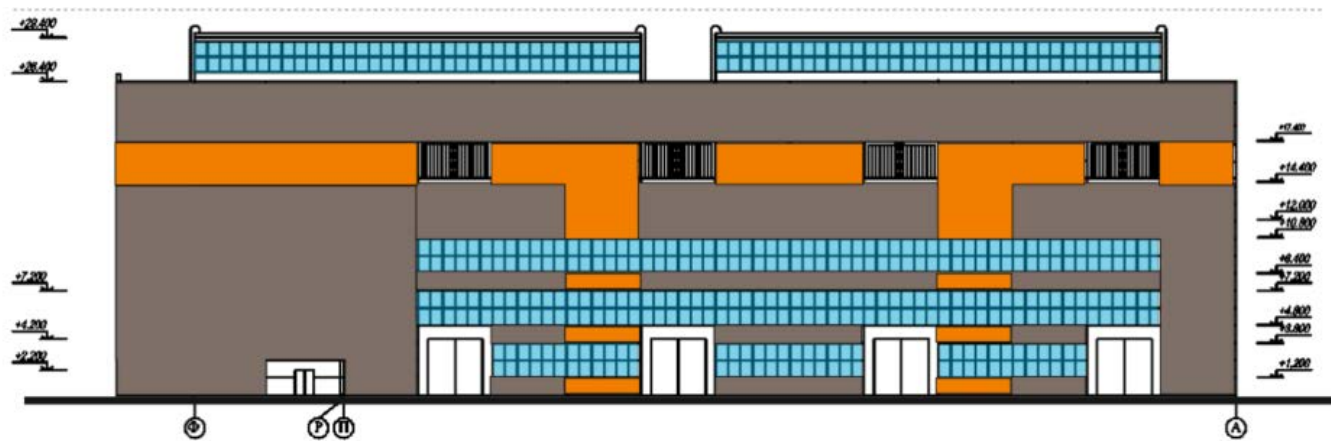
Схема розташування стінових панелей фасаду Ф-А
